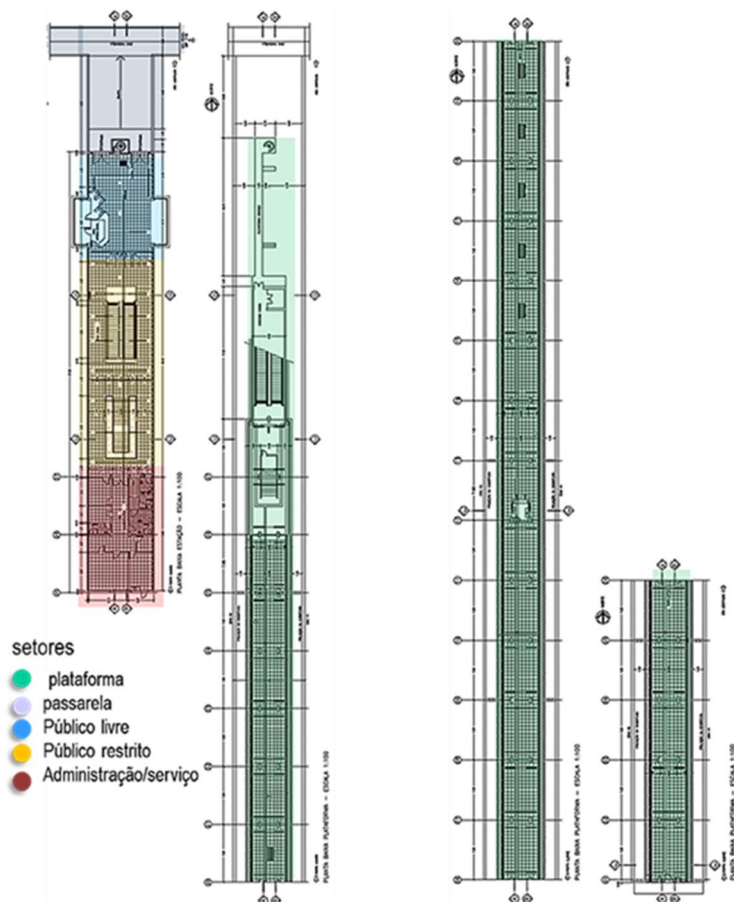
Planta Baixa/ levantamentos - Praças, passarelas e Estação/plataforma
